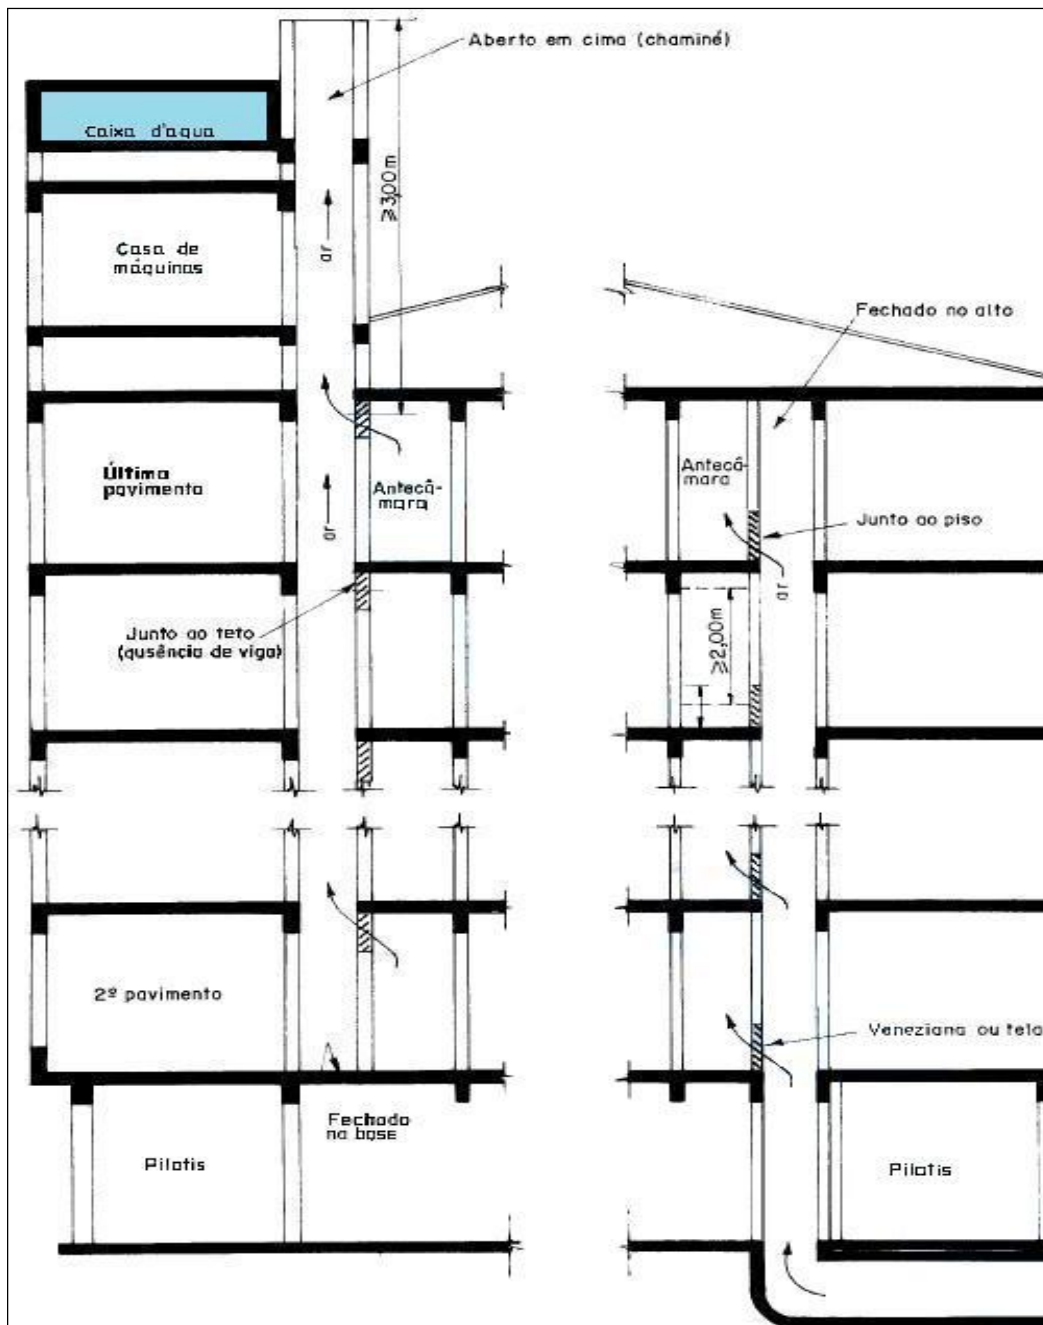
Escada enclausurada à prova de fumaça (demonstração dos dutos)
